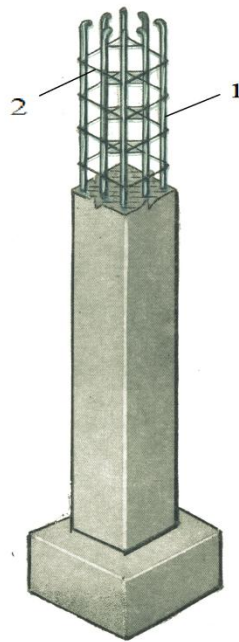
Характер роботи стиснутої колони: 1 - поздовжня арматура, 2 - поперечна арматура
